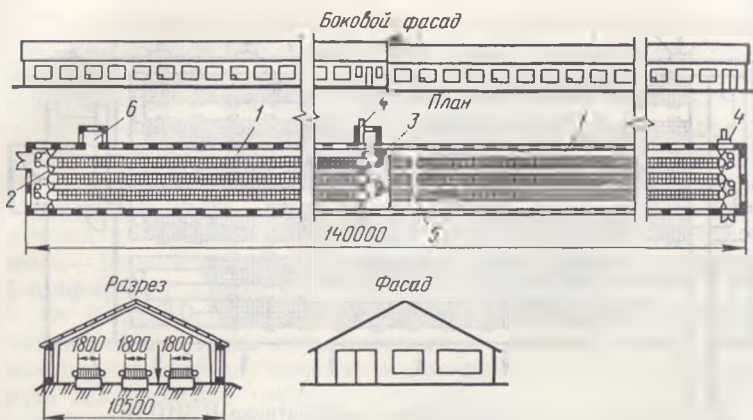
План, разрез и фасад крольчатника на 600 крольчих в зверосовхозе «Кошакровский» Татарской АССР (размеры в мм):
